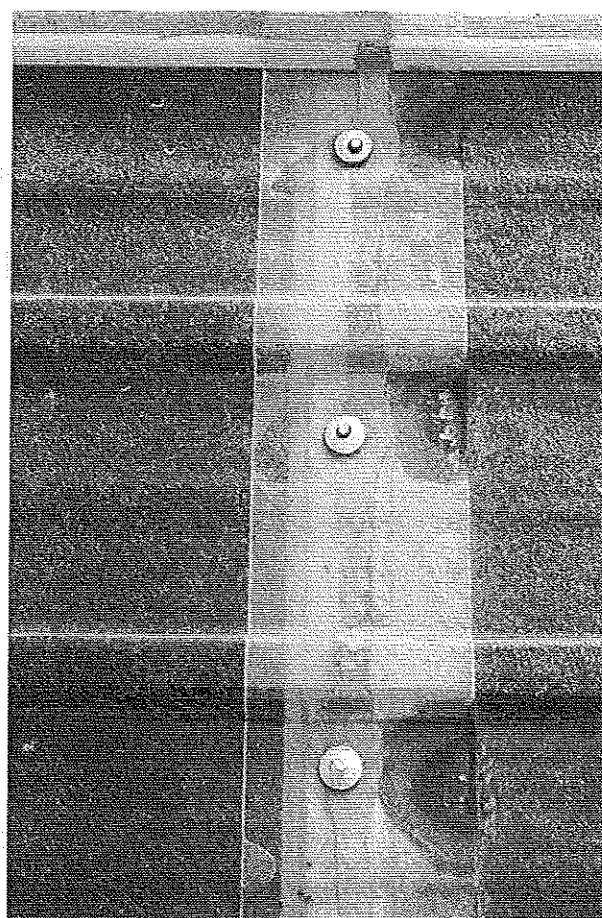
Plaque PRV en recouvrement avec autre plaque PRV. Fixations en place avec mastic. Accumulation des condensations dans la zone amont du recouvrement.
